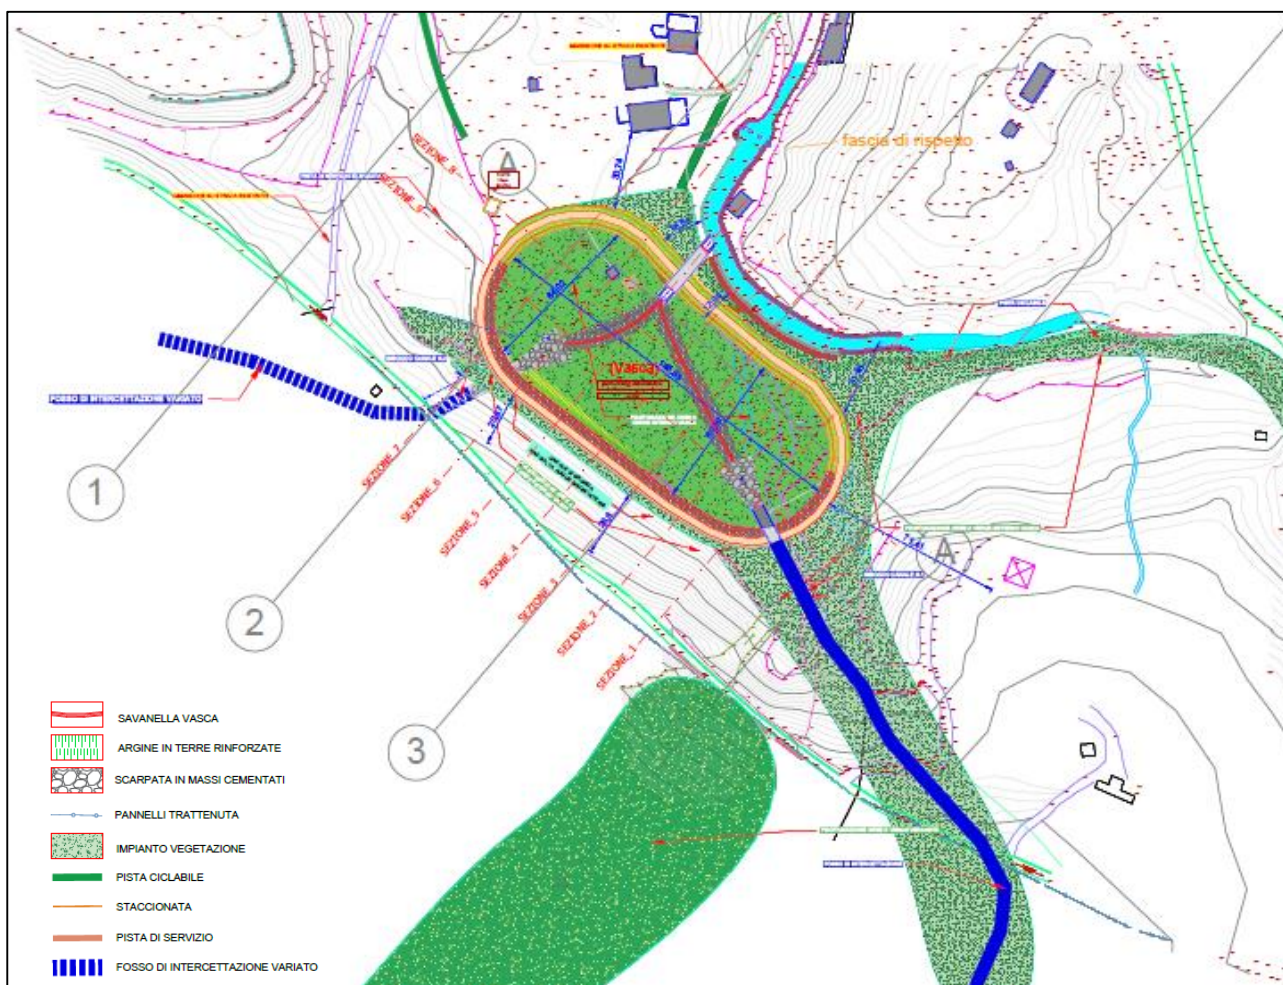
Planimetria generale Progetto RIELABORATO
